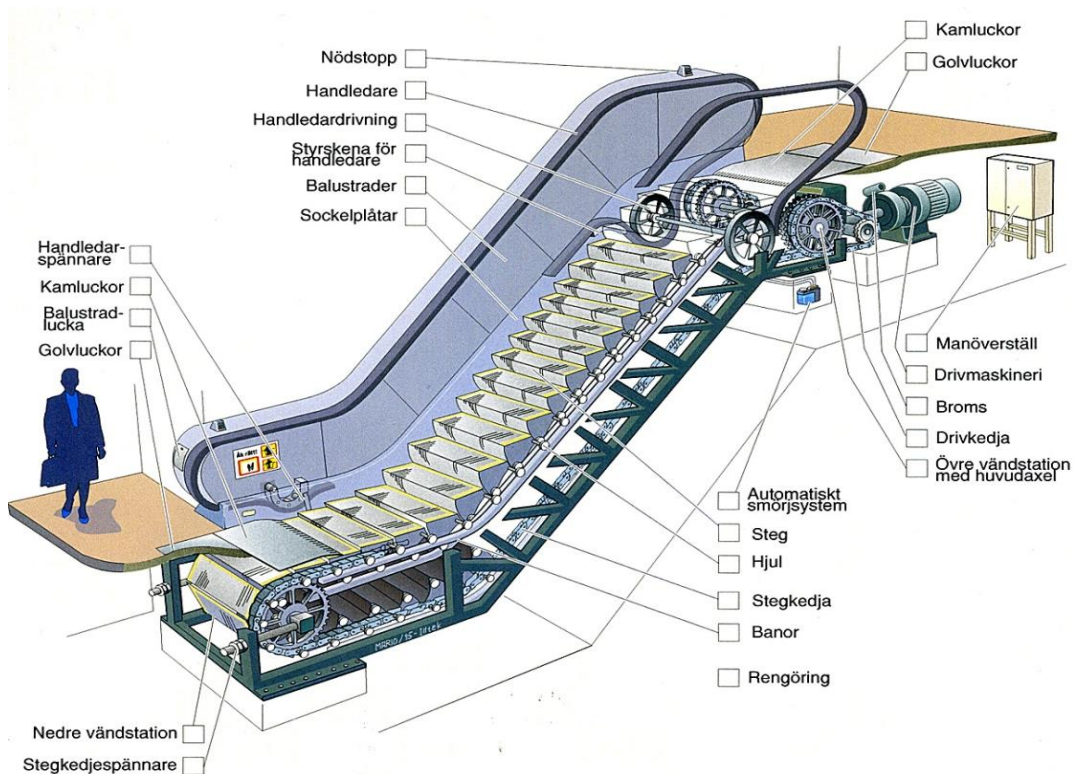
Översikt över rulltrappa och dess komponenter. Bild hämtad från: SL.
